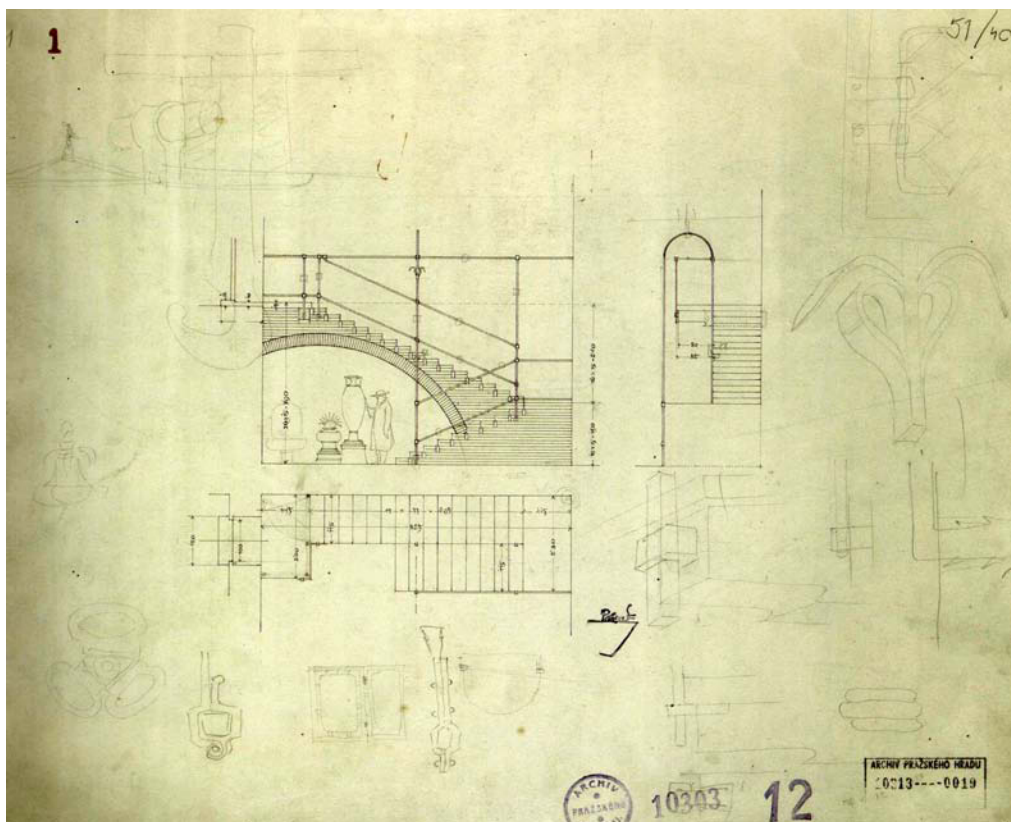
Wallgarten, Voliere, 1923, Plan.
